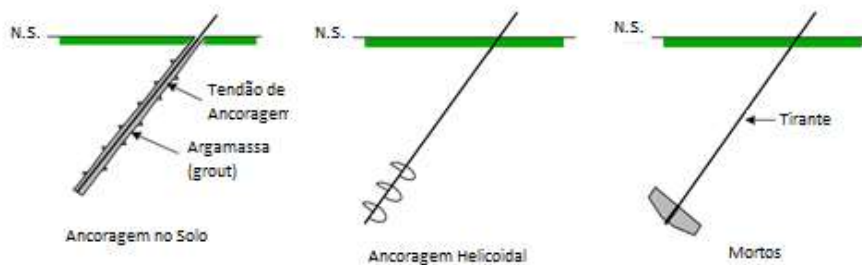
Fundações para Estais. Fonte: adaptado de [19]
